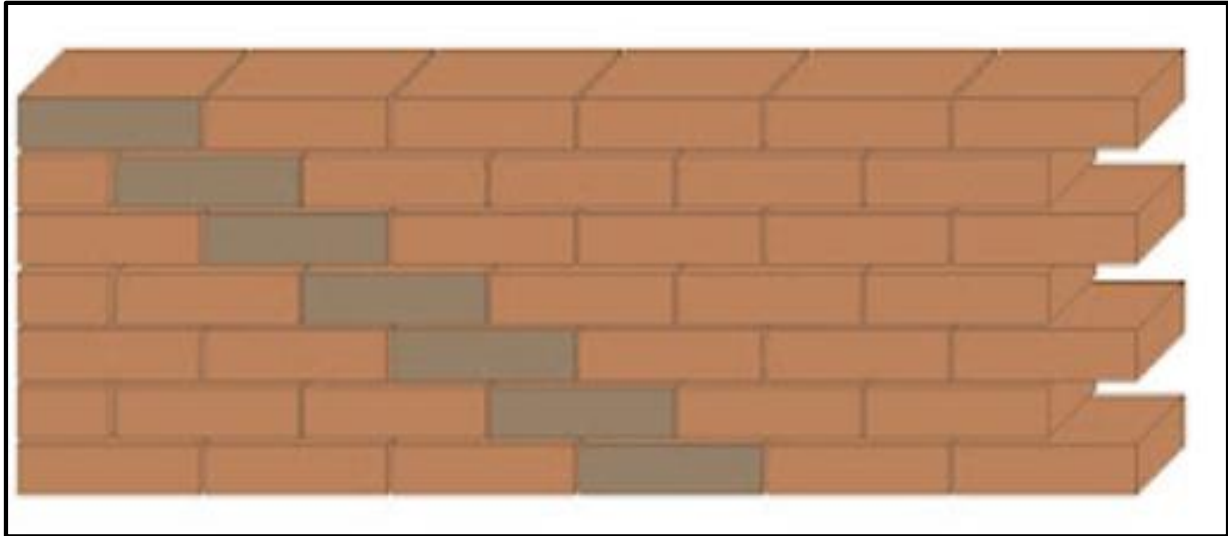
Muro de albañilería asentado con ladrillos en soga. Tomada de “Teoría básica sobre Albañilería”, por Donaire, 2011.
